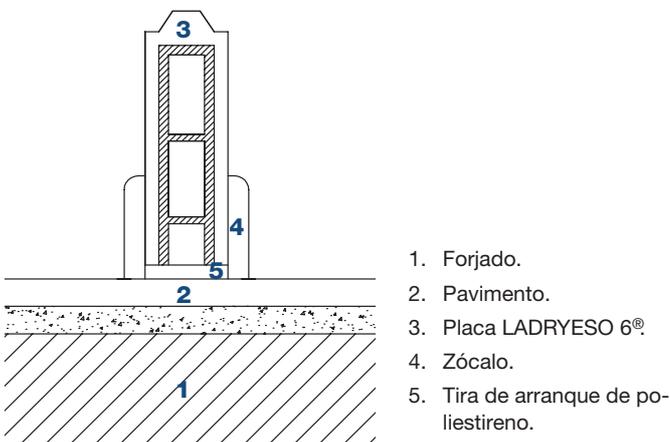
Colocación del tabique LADRYESO 6® sobre pavimento. Arranque con pieza cortada.
